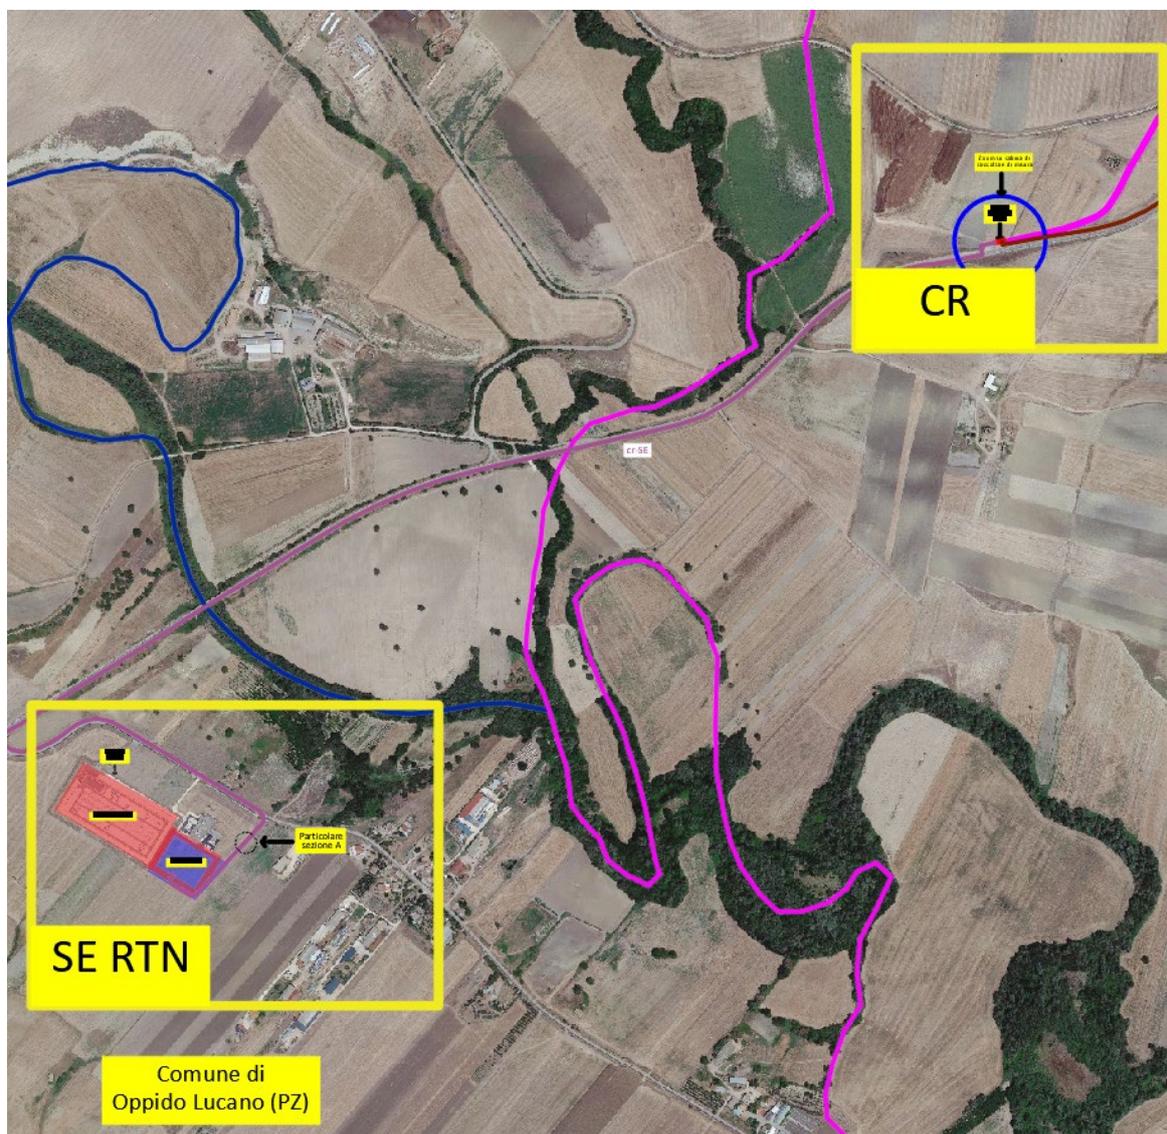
Collegamento CR con SE RTN “Oppido”.
